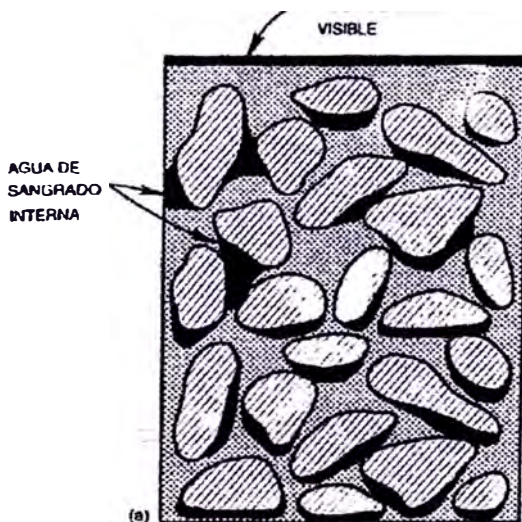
Esquema del sangrado interno y efecto pared de un concreto recién colocado (Ref 1)
